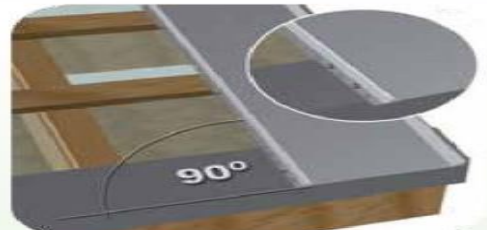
Die Paneele müssen senkrecht zur Traufe verlegt und mit 2 Schrauben befestigt werden.
